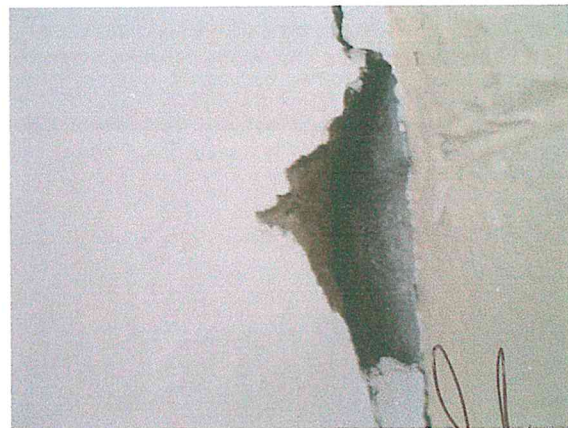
Muro divisorio "suelto" en el acceso a la oficina adyacente del área de Protección Civil. Se recomienda su sustitución por otro muro hecho con materiales ligeros prefabricados y sujetarlo a la trabe y columna interior existentes.
